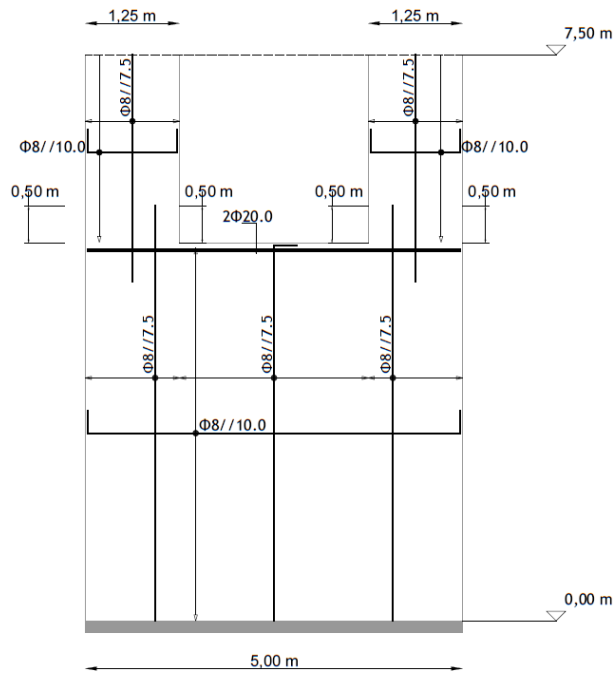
Vista em alçado da pormenorização das armaduras principais e suplementares da metade inferior parede com abertura a executar para cada uma das faces.
